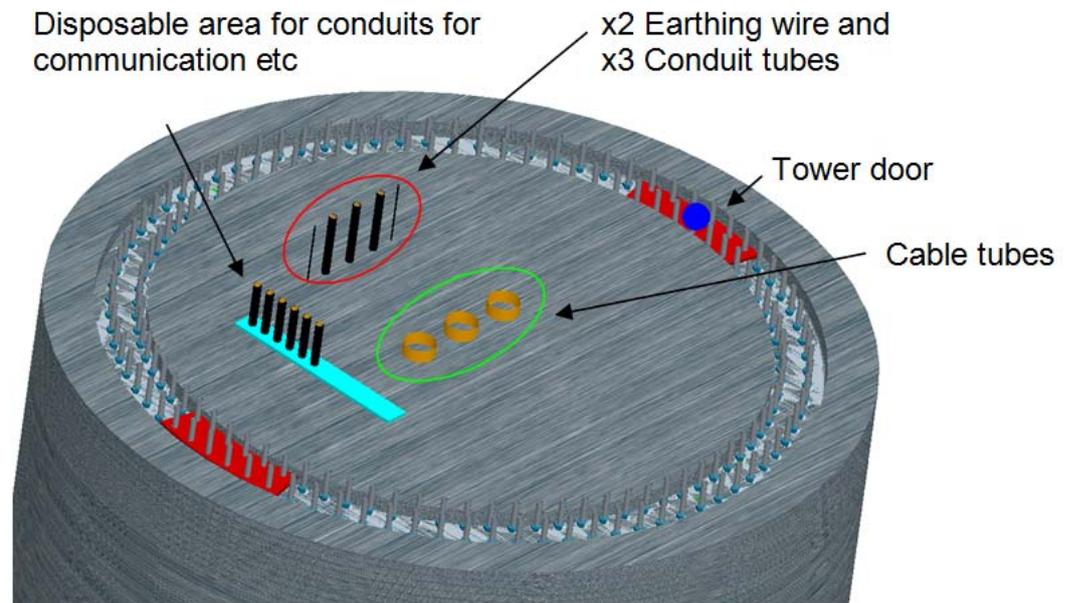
Leerrohranordnung zur Installation der Schaltanlage dargestellt an einem betonierte Fundament
